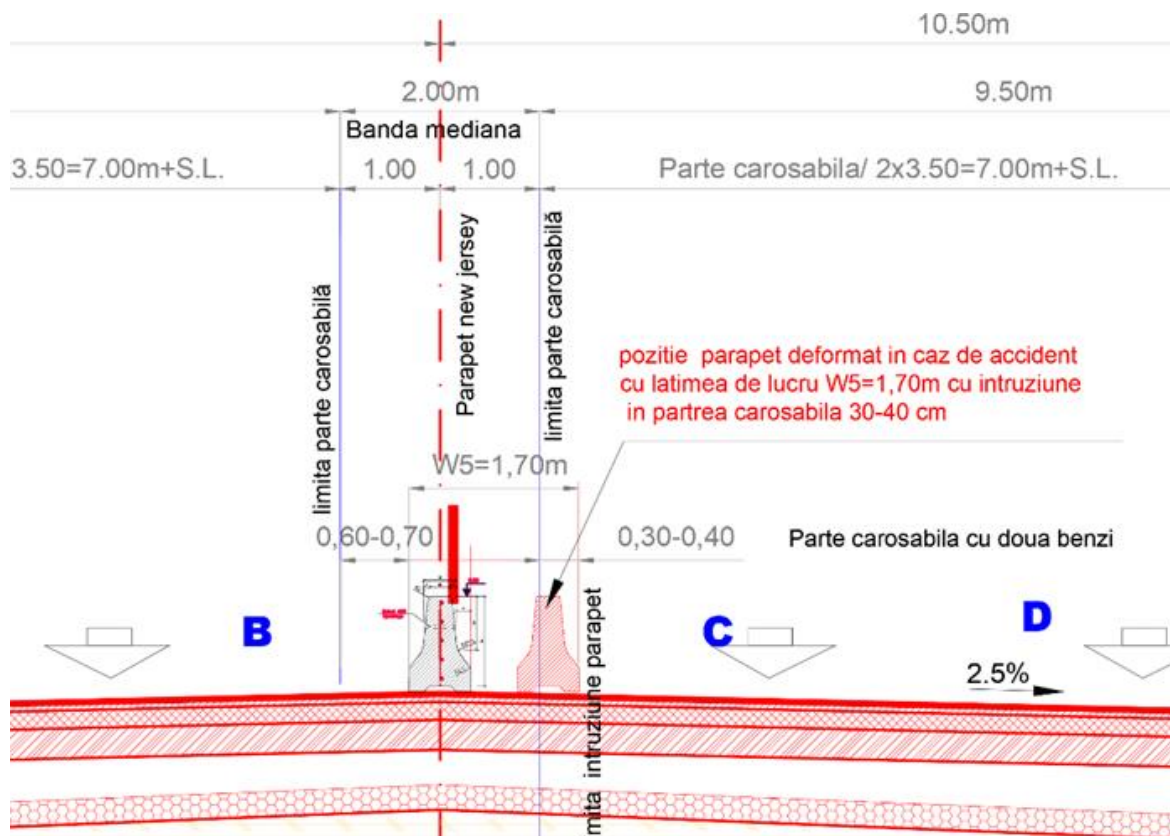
Detaliu intruziune parapet în partea carosabilă
